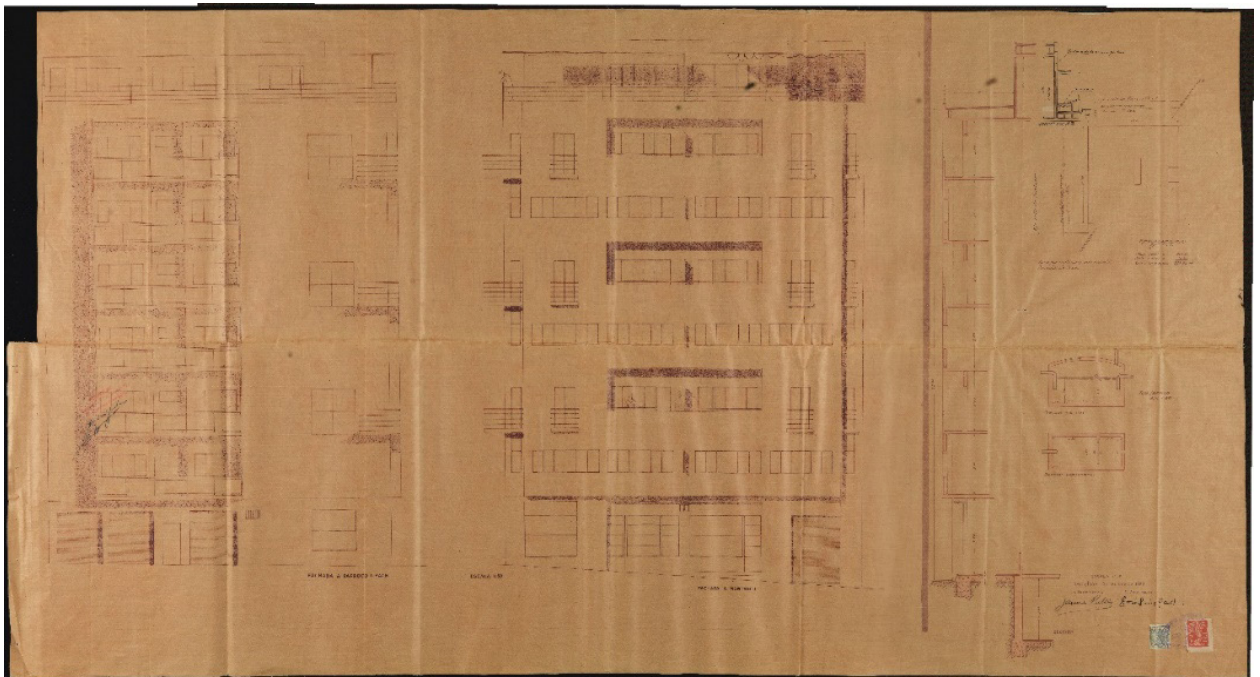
Plano de alzados y sección, del primer proyecto de Sert. Plano sin numerar. 1929. Expediente Fo-3756/1929. 1929. Arxiu Contemporani de Barcelona.
